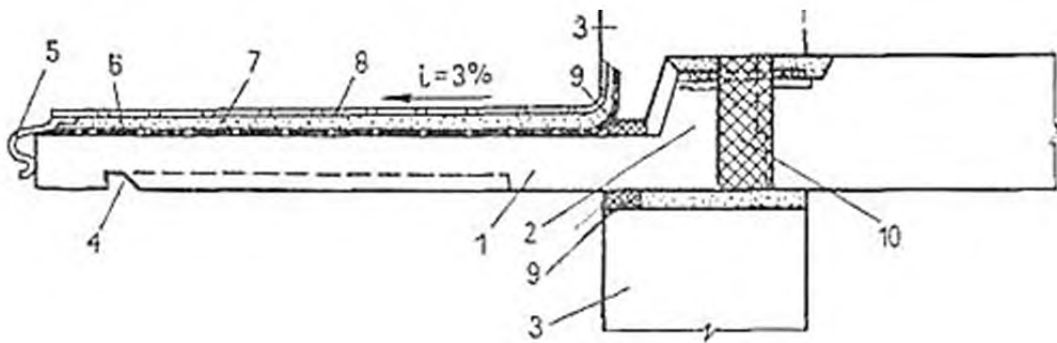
Стык балконной плиты с наружной стеной:
